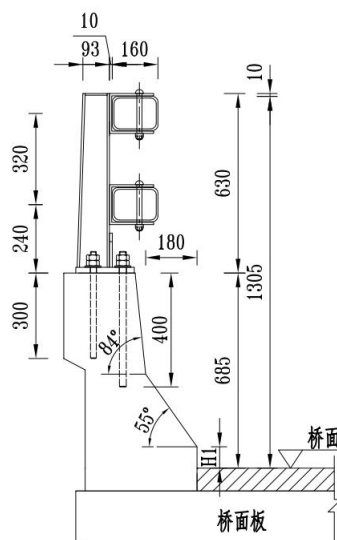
加强钢构件组合式桥梁护栏构造示意 (mm)
